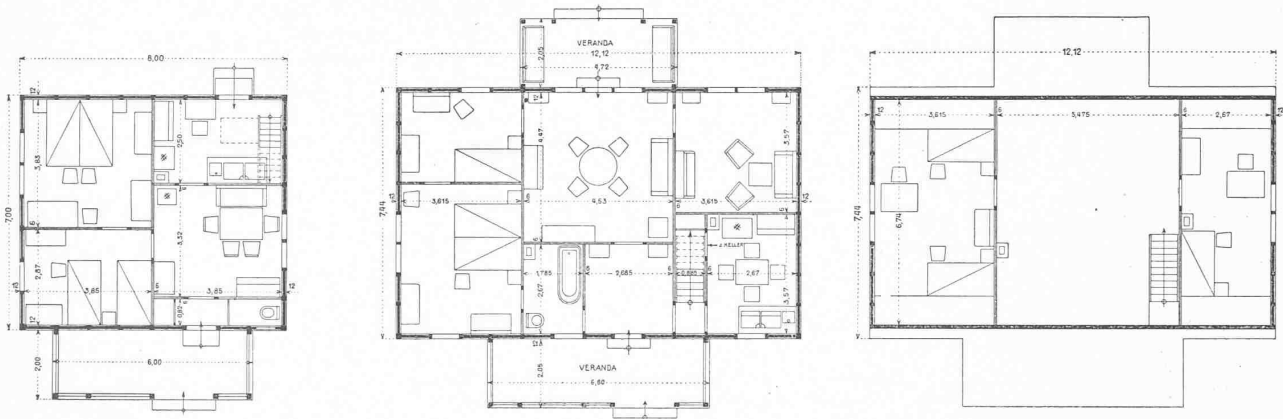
Grundriss-Typ 56 m². — Masstab 1:200. — Abb. 24 und 25. Grundriss-Typ 90 m² überbauter Grundfläche.
